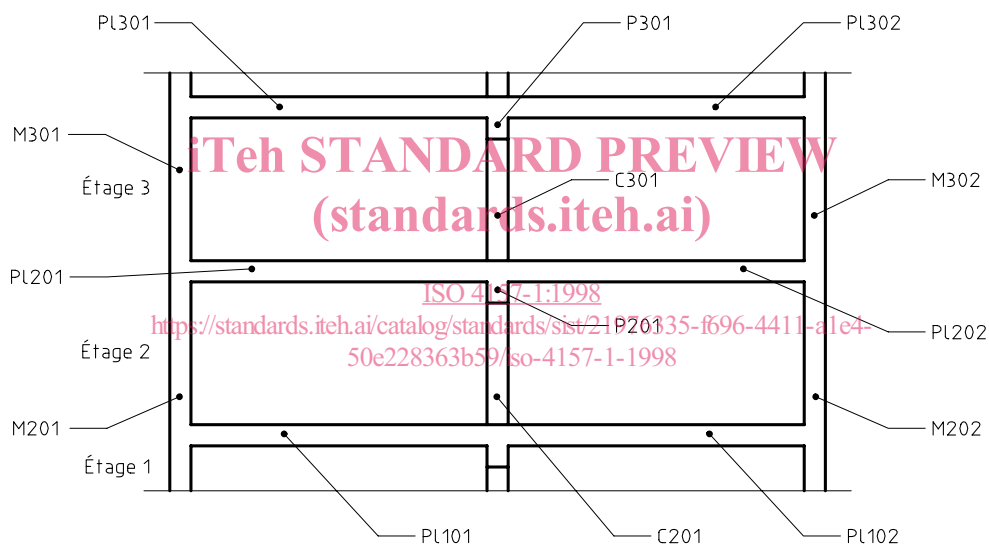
Exemple de désignation de colonnes, planchers, murs et poutres au deuxième étage
